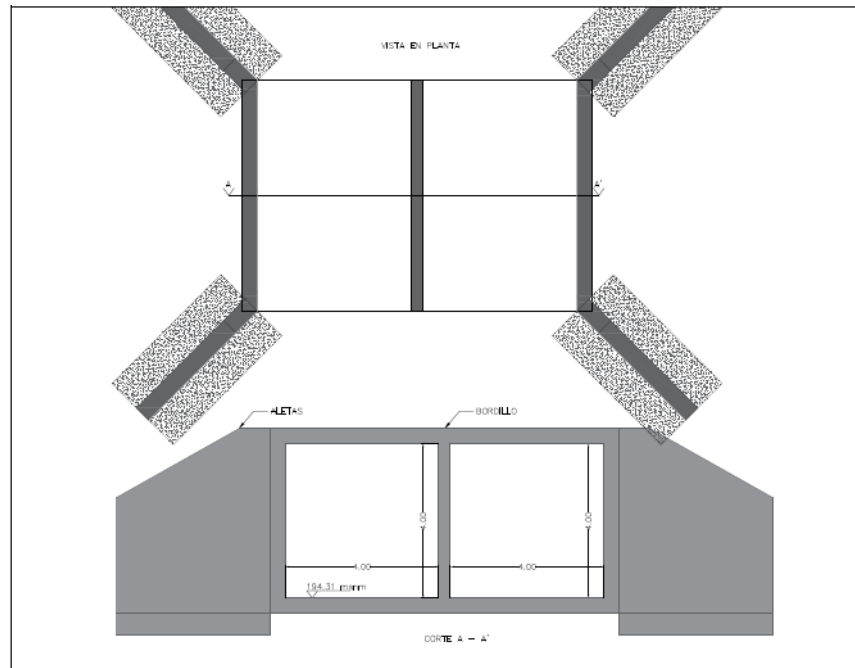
Detalle en planta Box Culvert sección cuadrada (1,00x1,00m y 1,50x1,50m).
